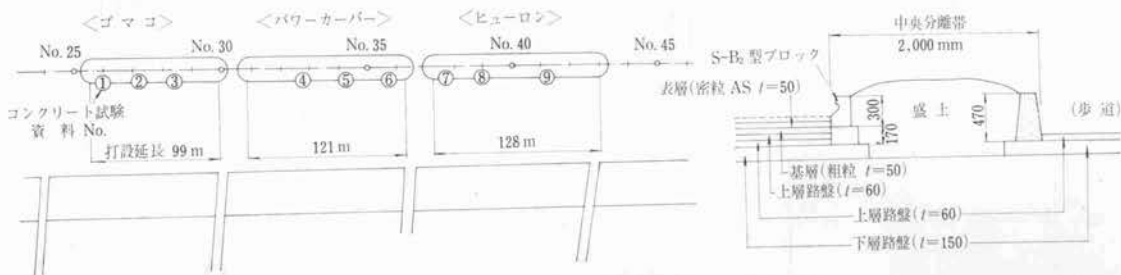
コンクリート連続成形機信頼性試験施工現場平面図
